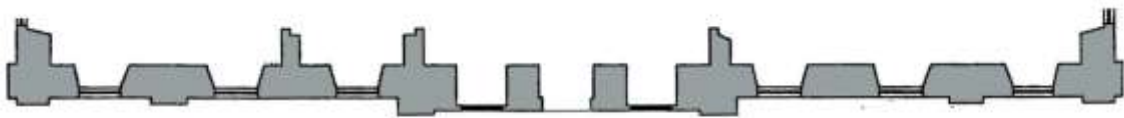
Planta da fachada principal. Solar da Marquesa de Santos.
